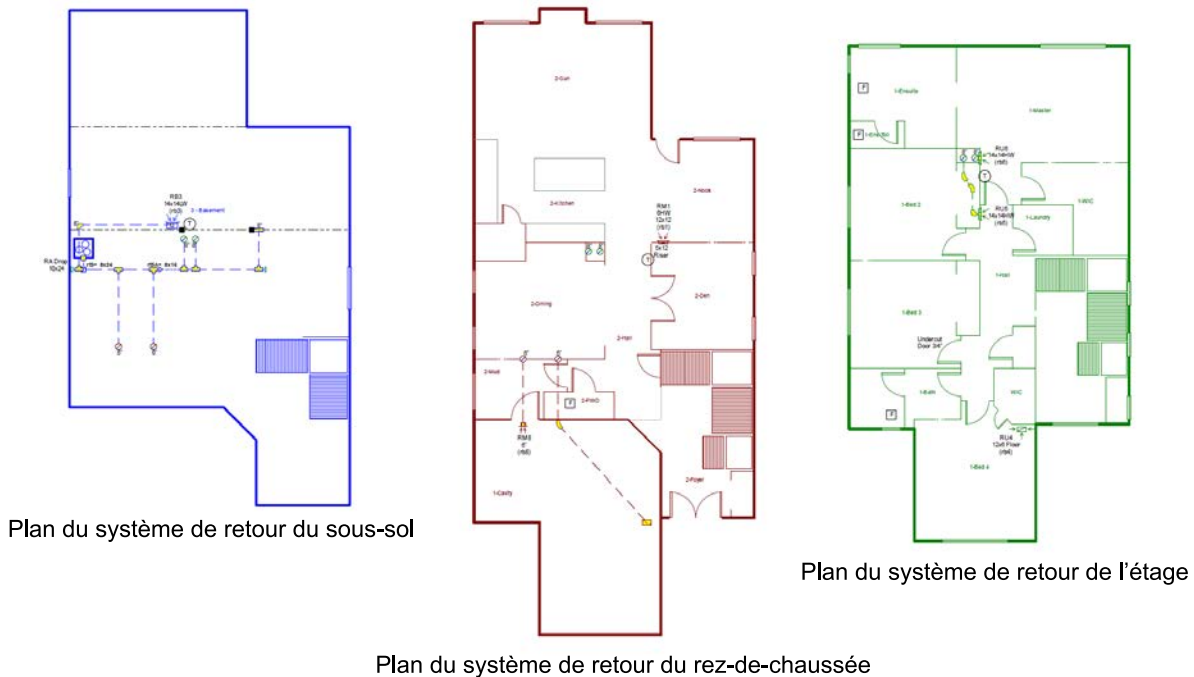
Plan des conduits de retour d'air de l'exemple de concept des conduits
